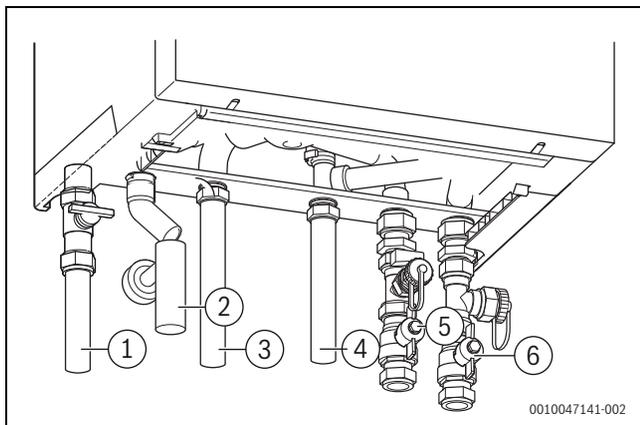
GB192i.2 Gas- und wasserseitige Anschlüsse (Zubehör)
